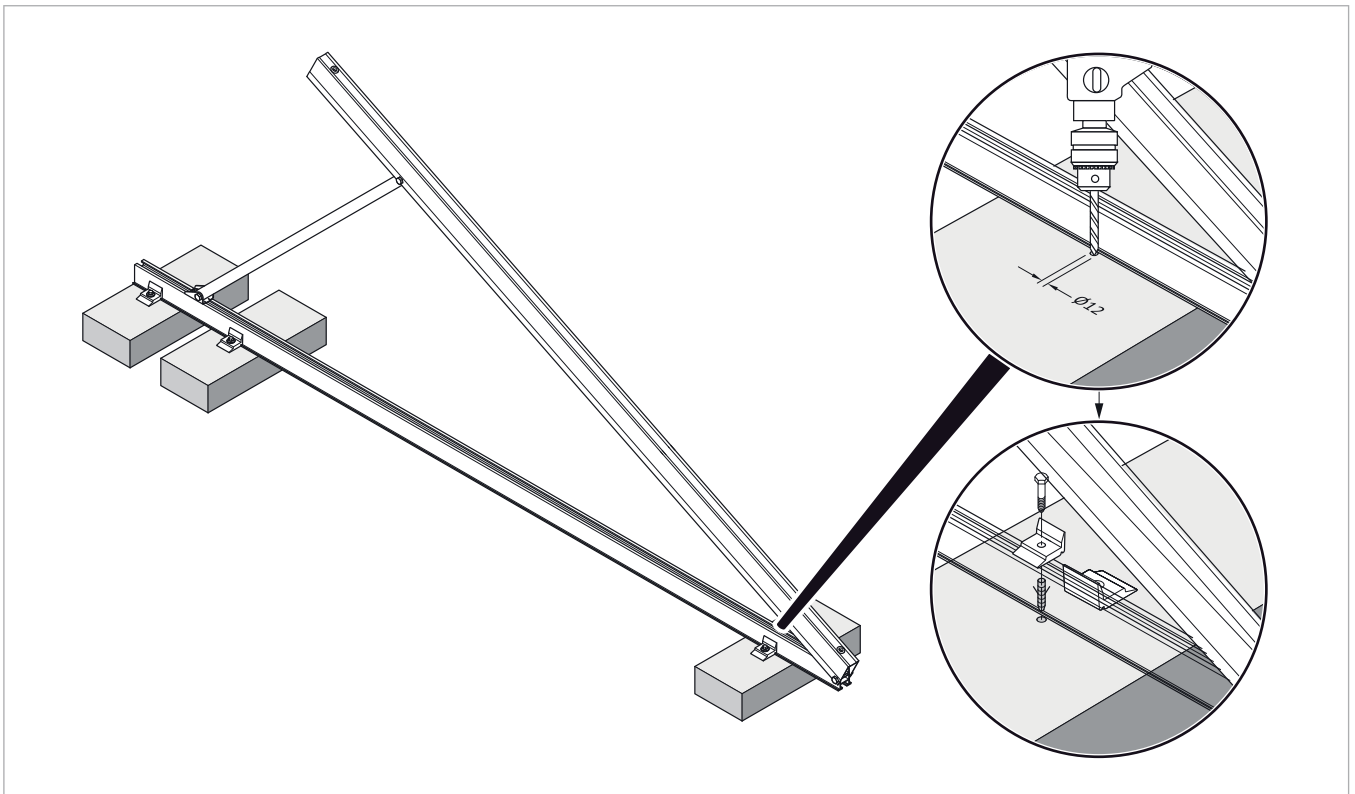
Montaje del soporte para tejado plano en piedra de hormigón
